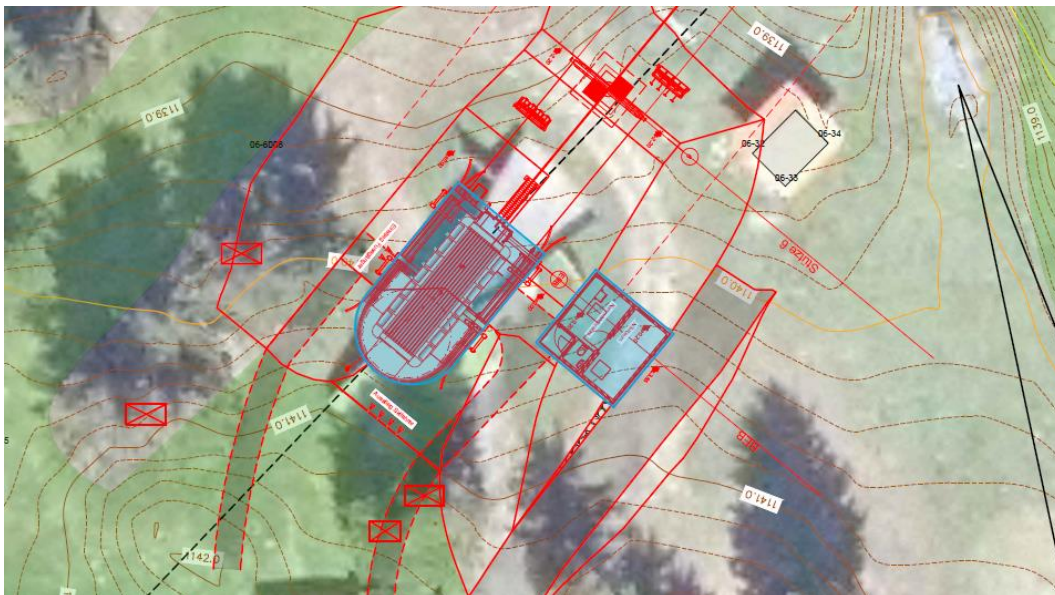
Dachfläche der Bergstation inkl. Kommandoraum (blaue Schraffur) und Versickerungsfläche (pinke Schraffur)
